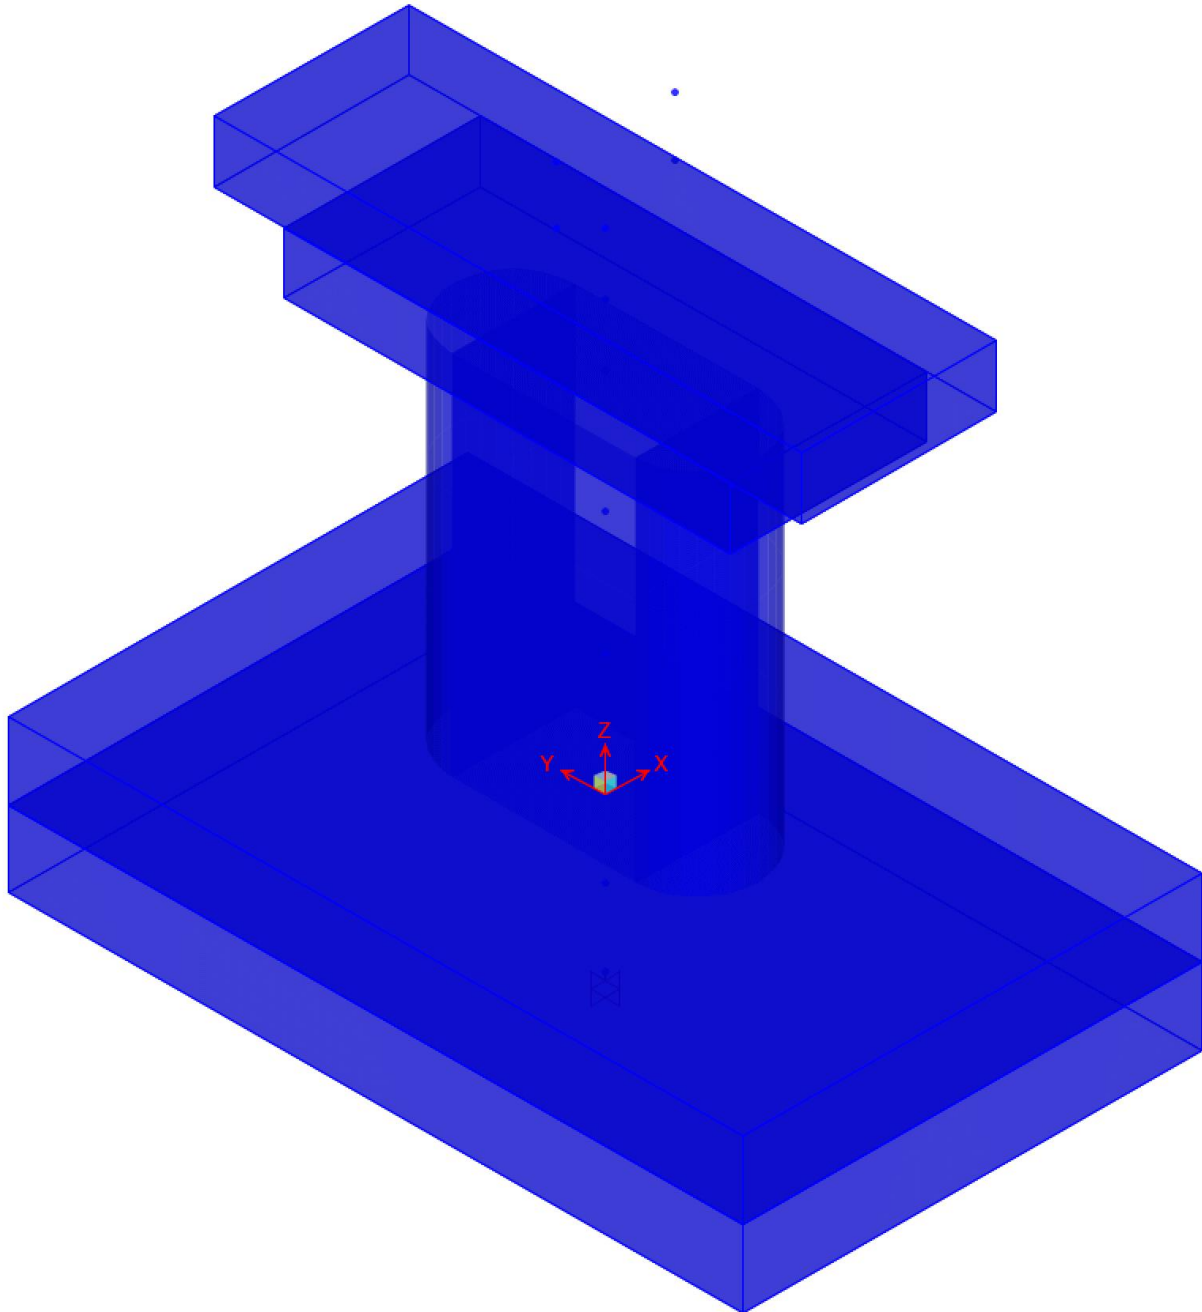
Vista del modello 3D agli E.F. – Vista estrusa
